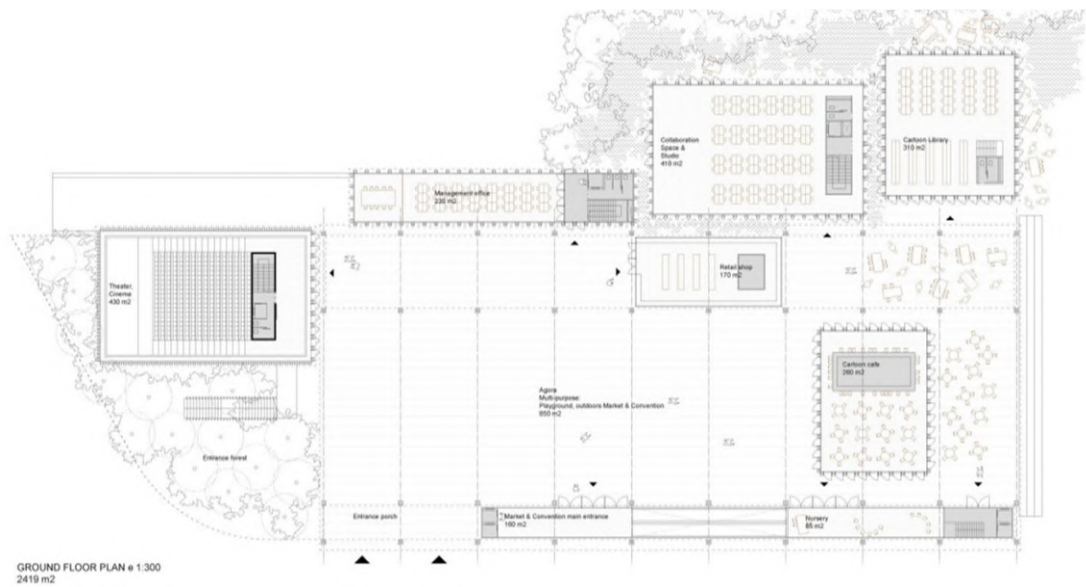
План 1-го поверху Центру мультиплікації, Південна Корея, арх. BETA Architects, 2016 [2]
